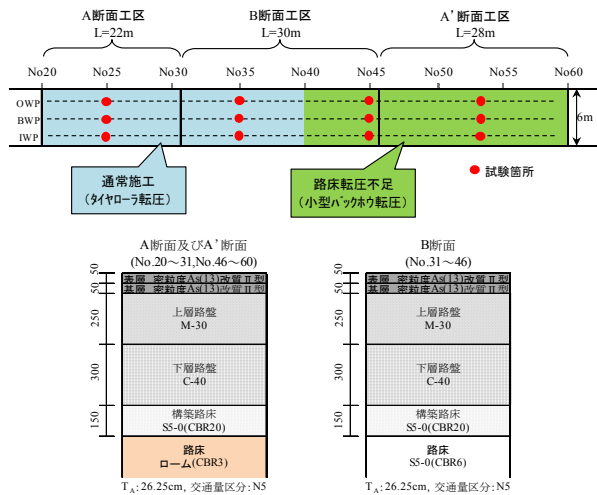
試験施工検討工区（上；平面図，下；断面図）
